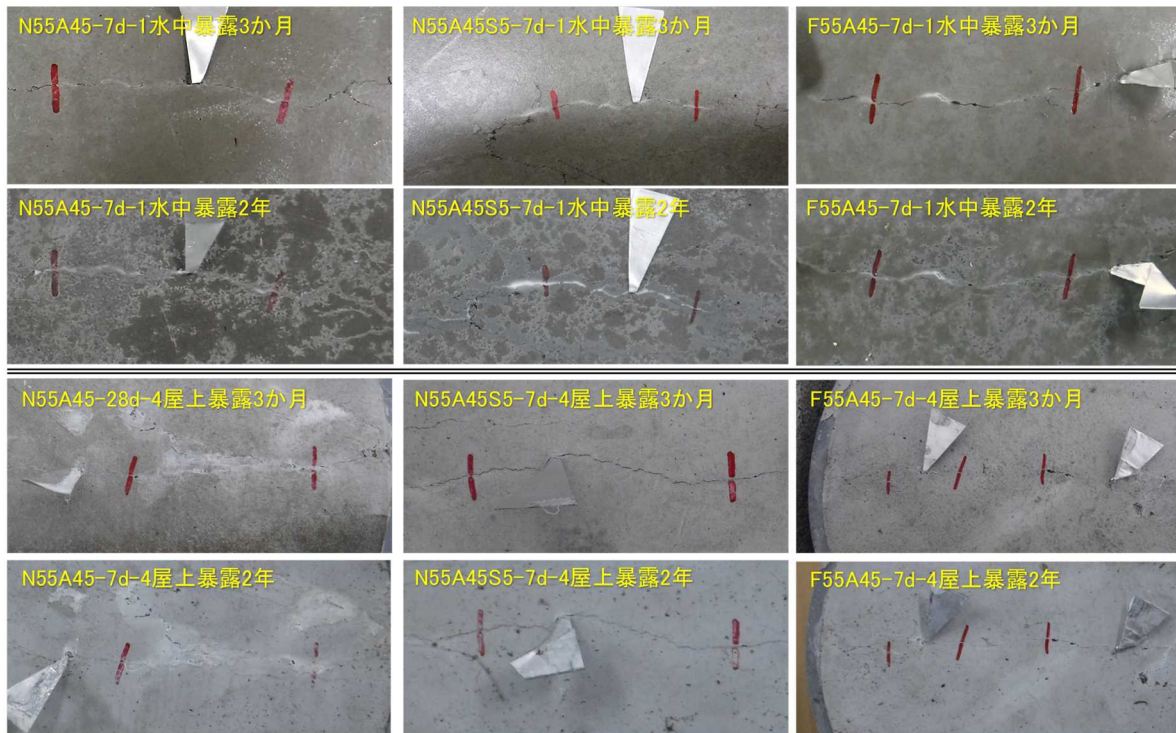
暴露3か月と2年後の底面のひび割れ自己充填状況
